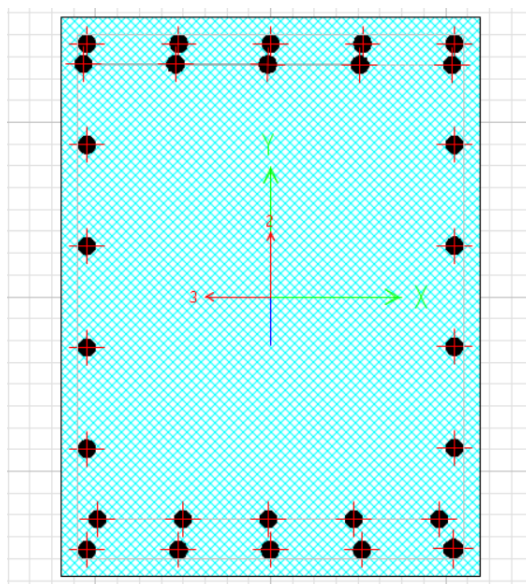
Columna pila de las abscisas 1+137.70 armado existente
